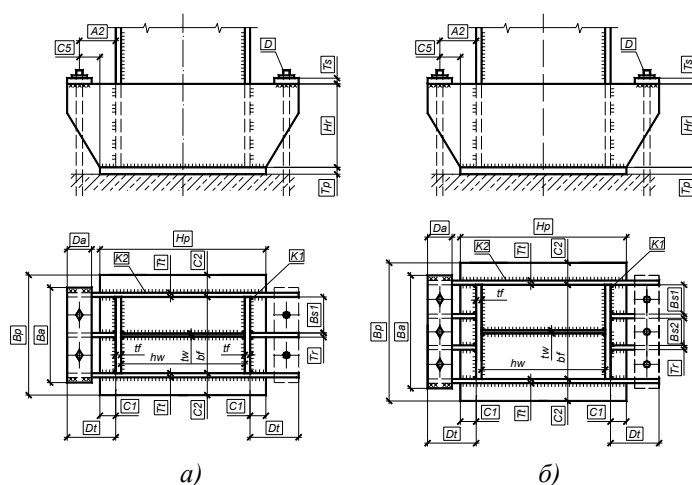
Типы конструктивных решений узлов жестких баз колонн с выносными траверсами.
